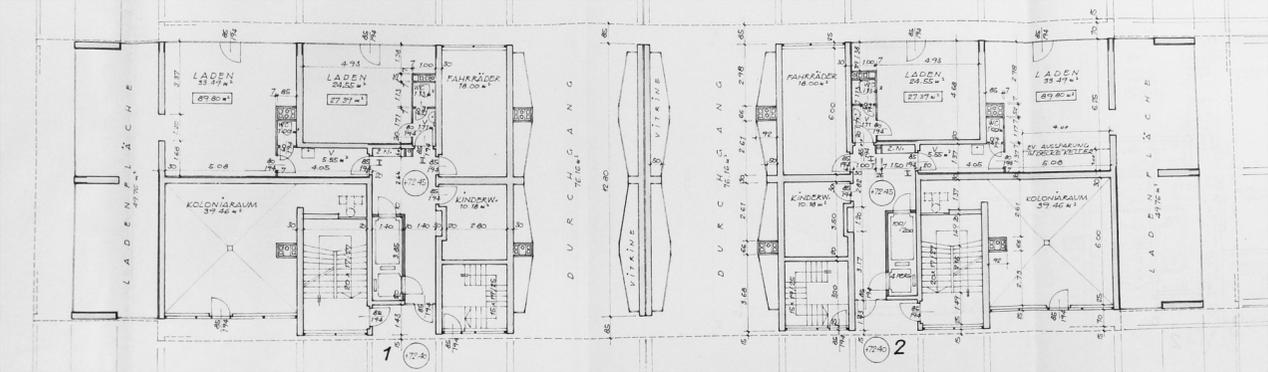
Grundriss Erdgeschoß Einreichung Nr. 32
